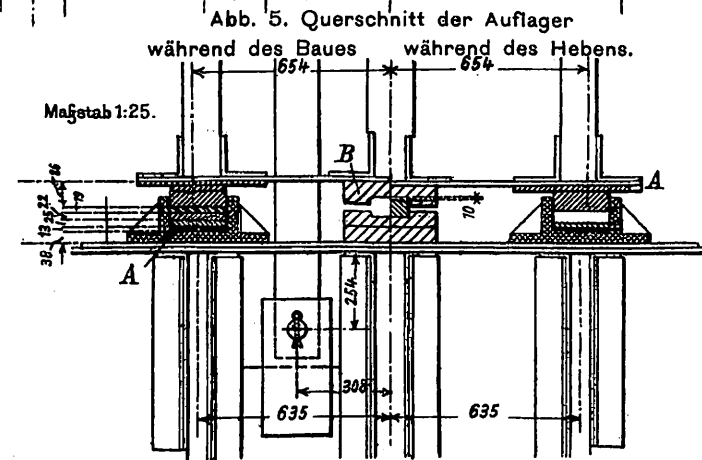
Querschnitt der Auflager während des Baues während des Hebens.
